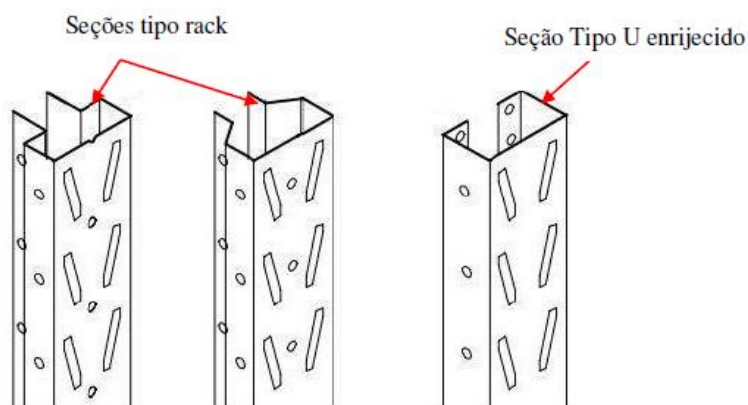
Tipos de perfis/seções utilizadas nas colunas dos Porta Pallets
